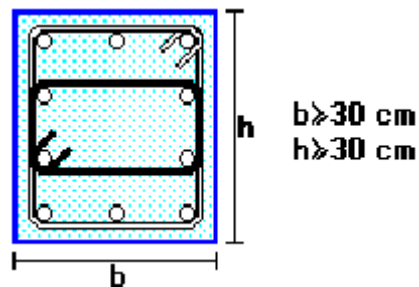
Sección transversal mínima de columnas para zonas sísmicas.
